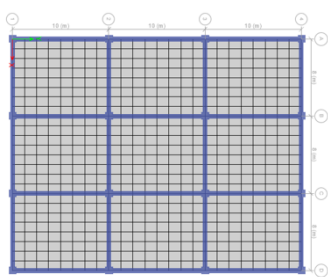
Planta de modelo de 20 niveles orientado en Eje Y
